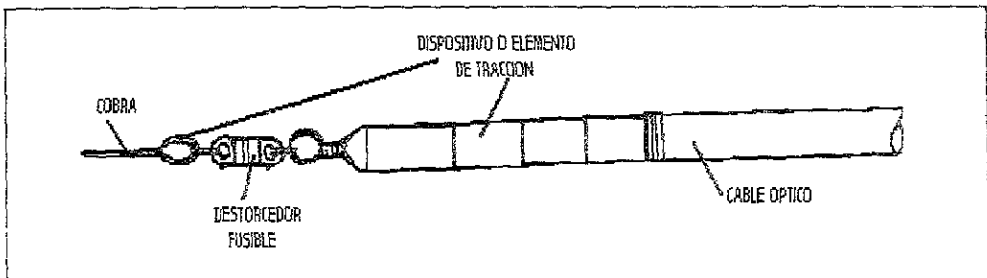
Jalado del cable óptico con elemento de tracción.
